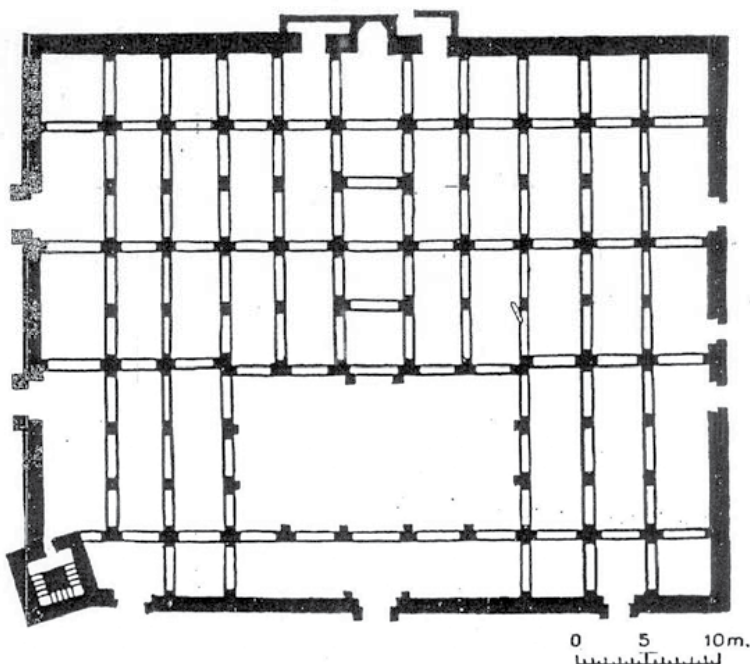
جامع الأندلسيين، مسقط أفقي، عن:
